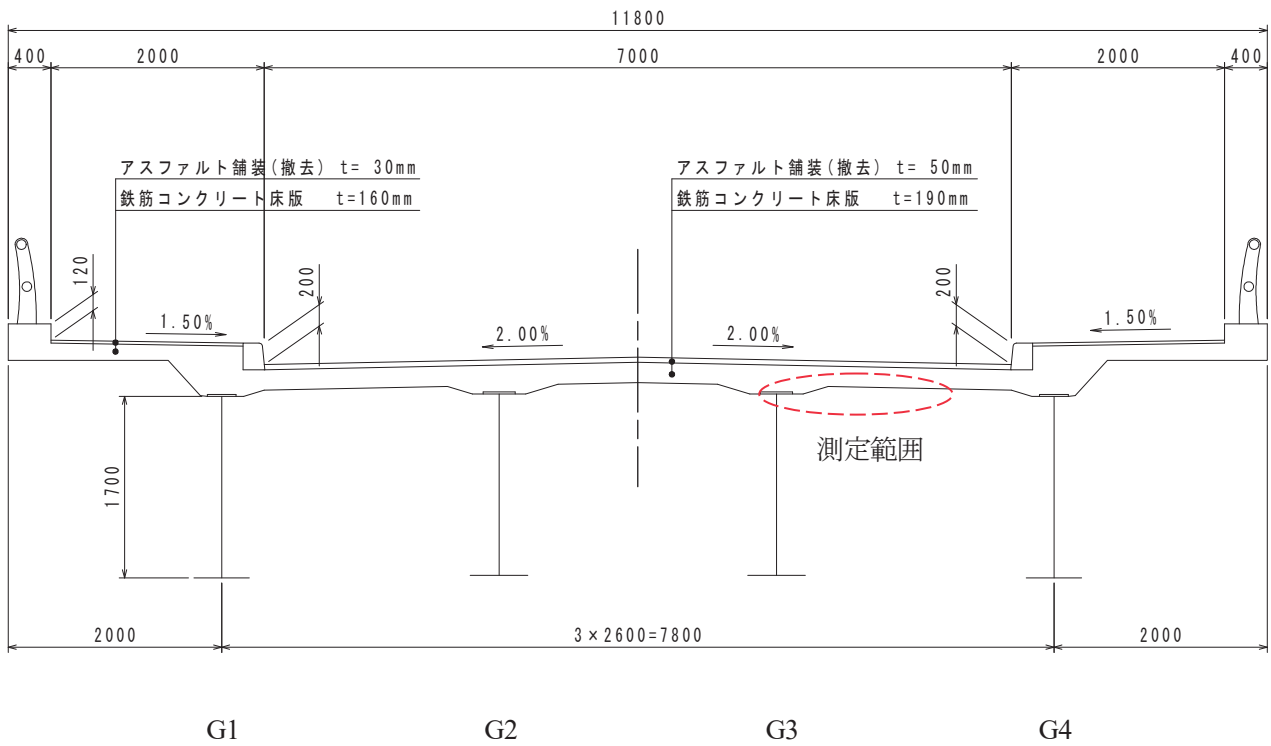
補強前断面図 (A1側から見た図, 右が上り車線)
